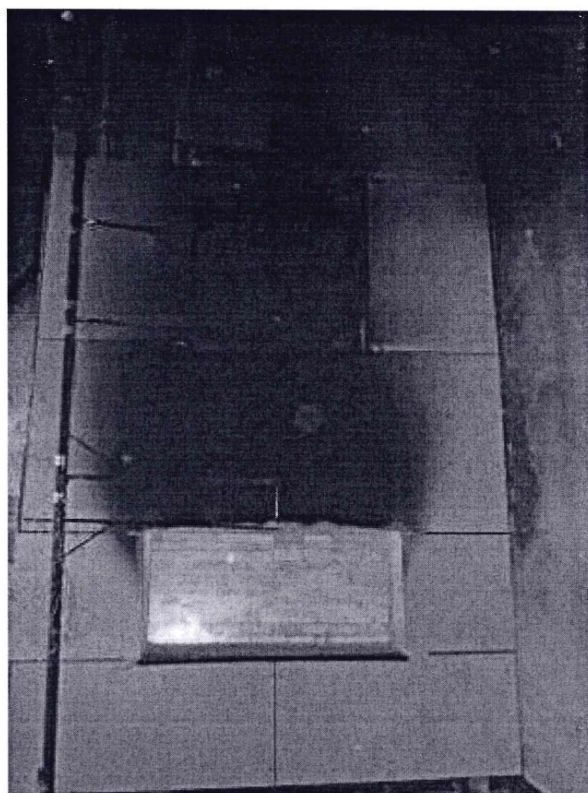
Фрагмент образца фасада после испытания по ГОСТ 31251-2008.
